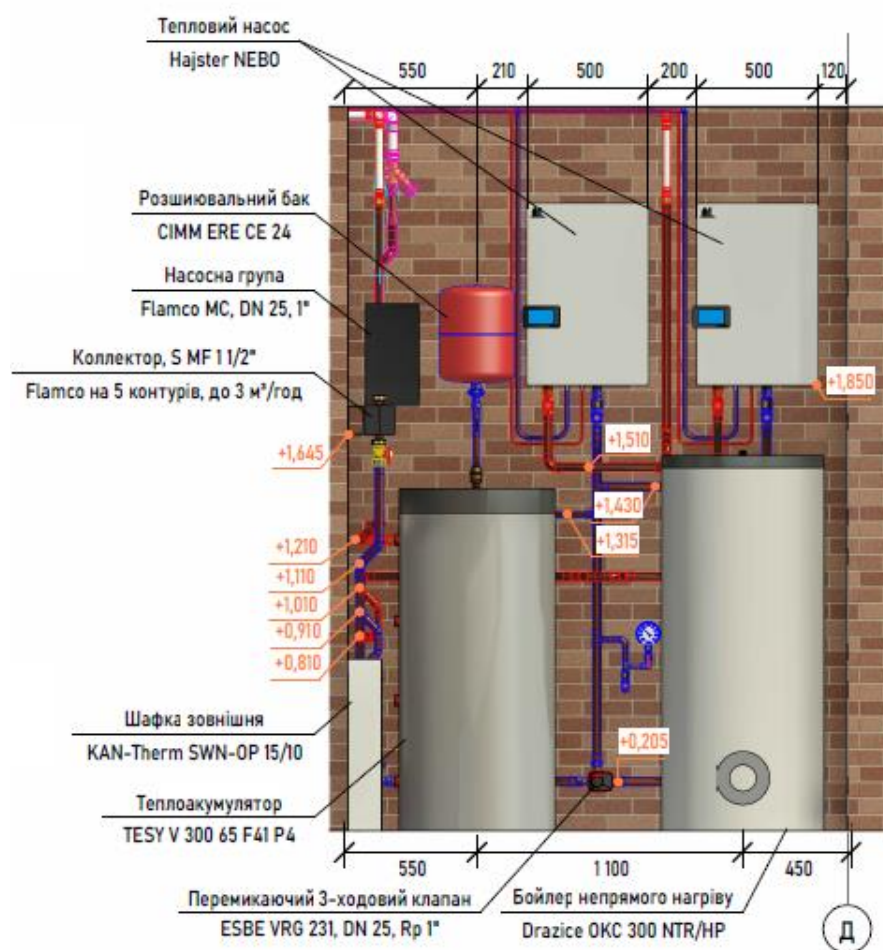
План котельні 1-го поверху. Ч3
